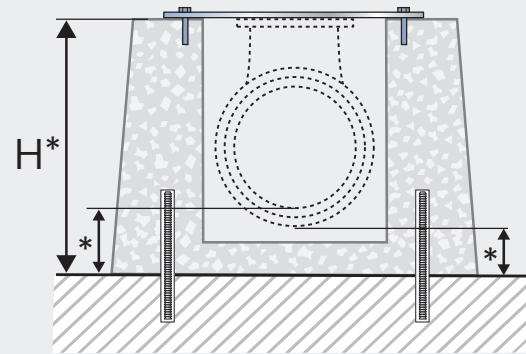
Бетонный фундамент с плитой-основанием на минимальном необходимом расстоянии для монтажа трубопровода и колена всасывающего патрубка.
